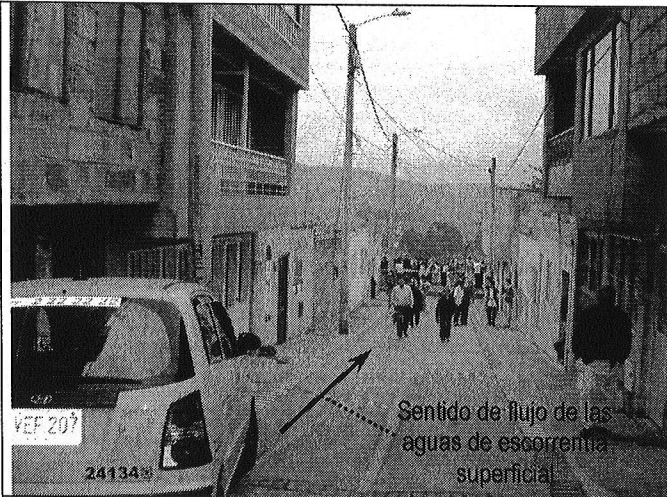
Sector de la Carrera 5A a la altura de la Diagonal 51 Sur. Se observan las trazas de lodo sobre la Carrera 5A, posiblemente derivadas del rebose del Alcantarillado, adicionalmente se observa una rejilla por la cual se encausan las aguas de escorrentía superficial hacia la red de alcantarillado.
